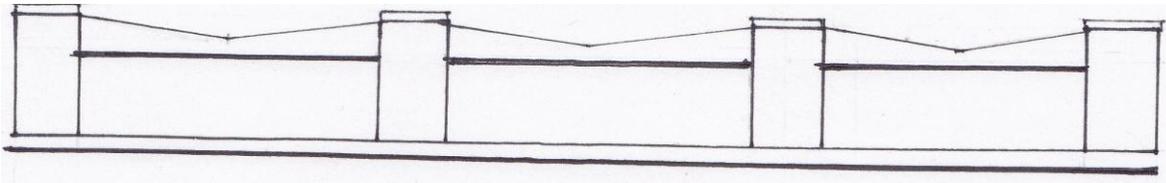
Decoración remate de fachada. Elaboró: Mauricio Sosa
